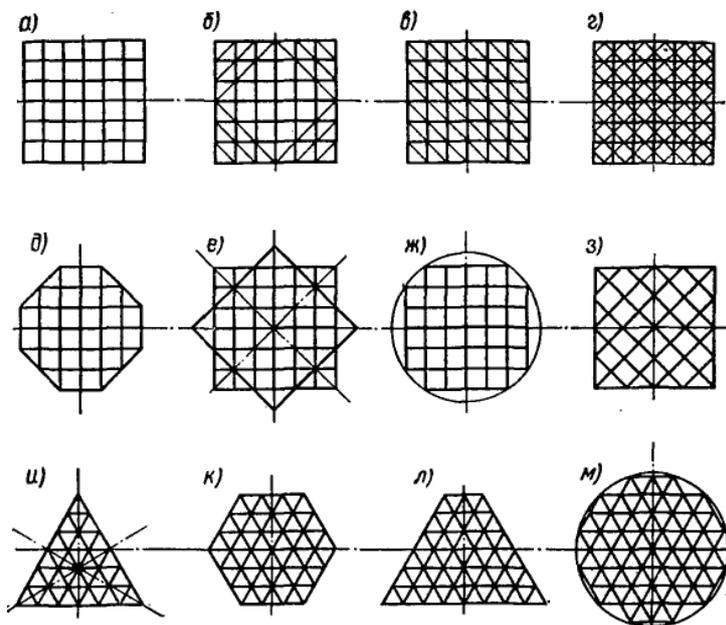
Основные схемы покрытий (а-м) из вертикальных перекрестных балок и ферм
